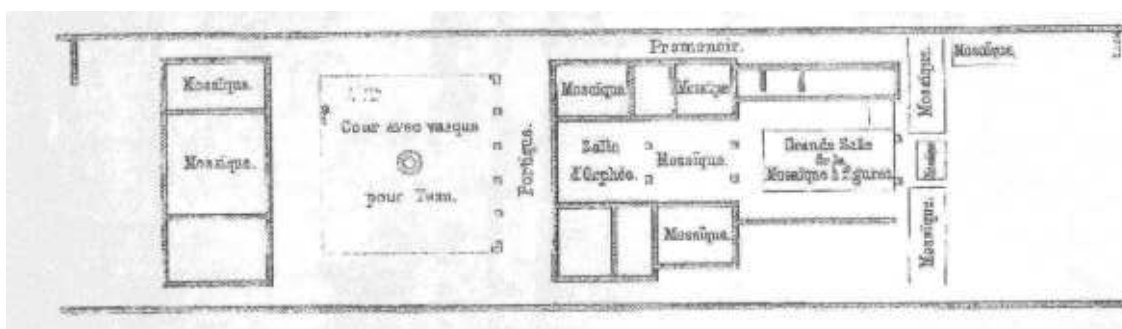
Planimetria della Domus A disegnata da M. B. Aubé, 1872.
